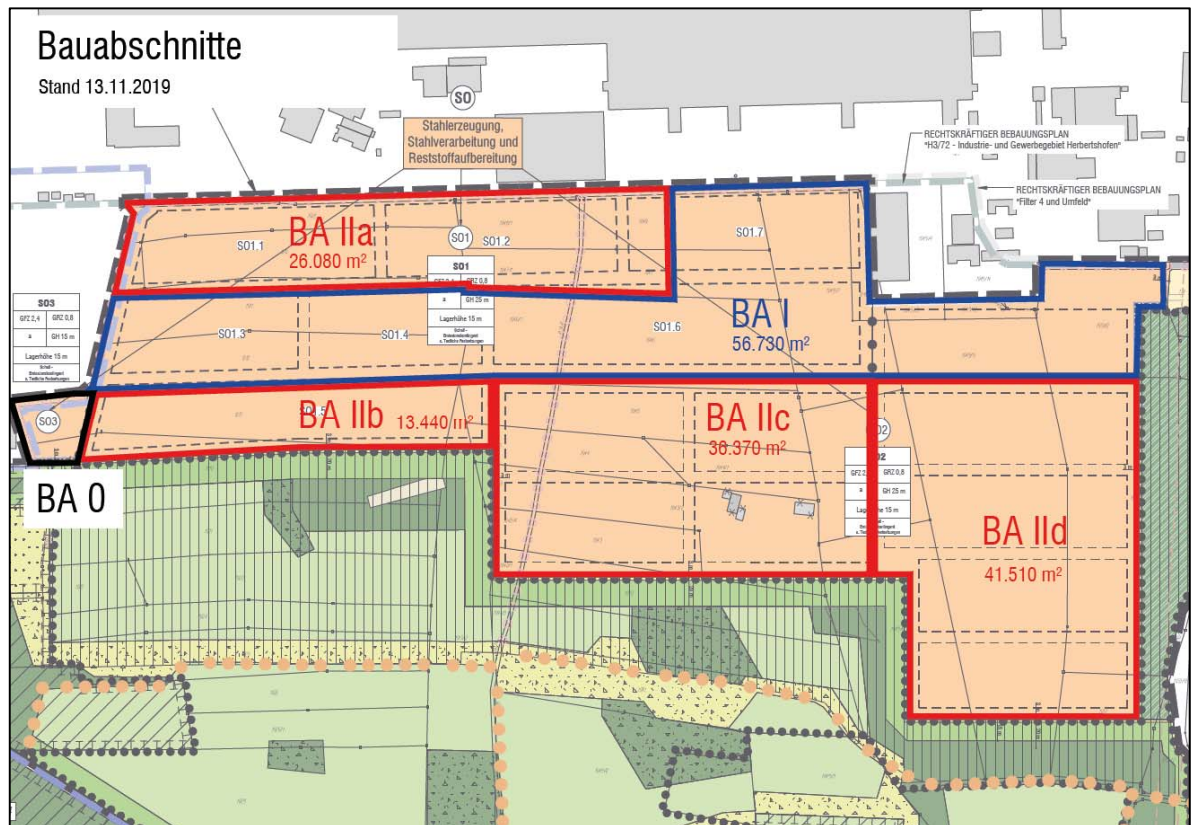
Darstellung aller geplanten Bauabschnitte
